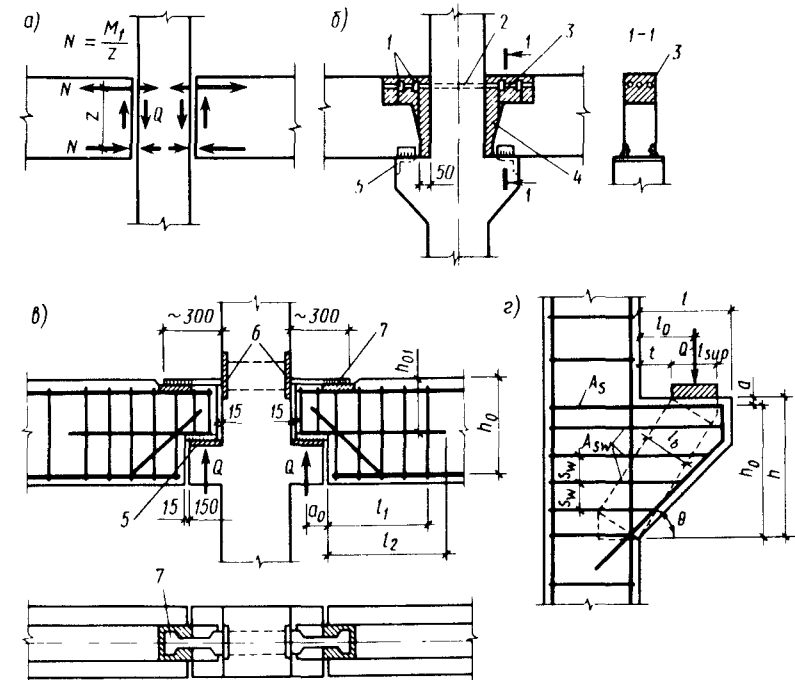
Стыки ригелей с колоннами: 1 — ванная сварка; 2 — стыковые стержни; 3 — вставка арматуры; 4 — бетон омоноличивания; 5 — монтажный сварной шов; 6 — закладные детали; 7 — накладка «рыбка»
